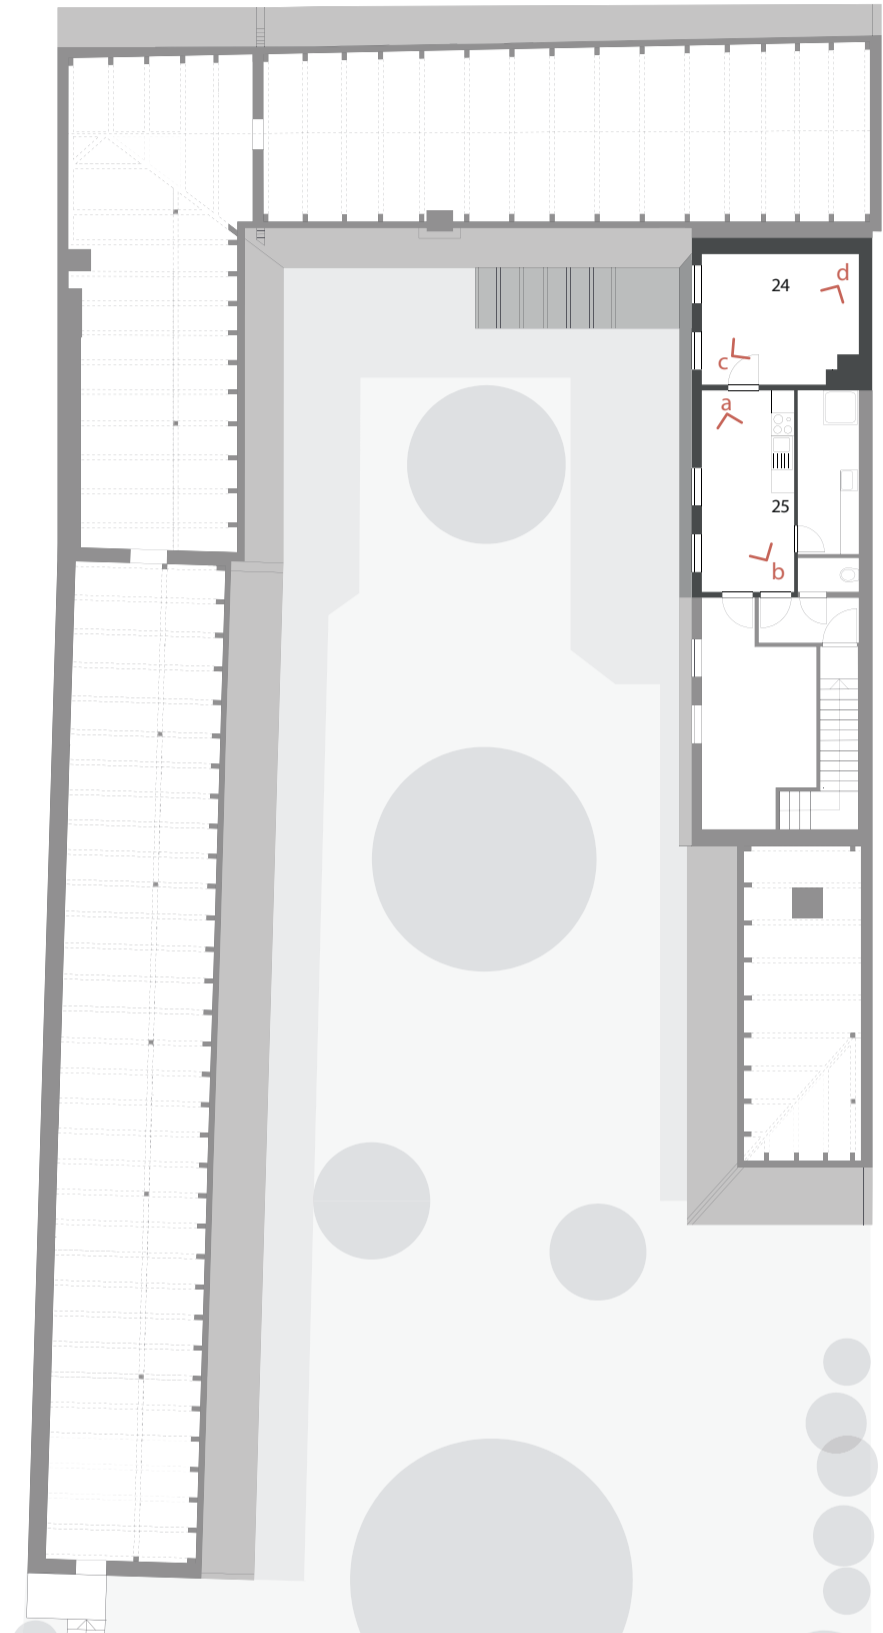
Grundriss Dachgeschoß | M 1:200 | Raum 24, 25
